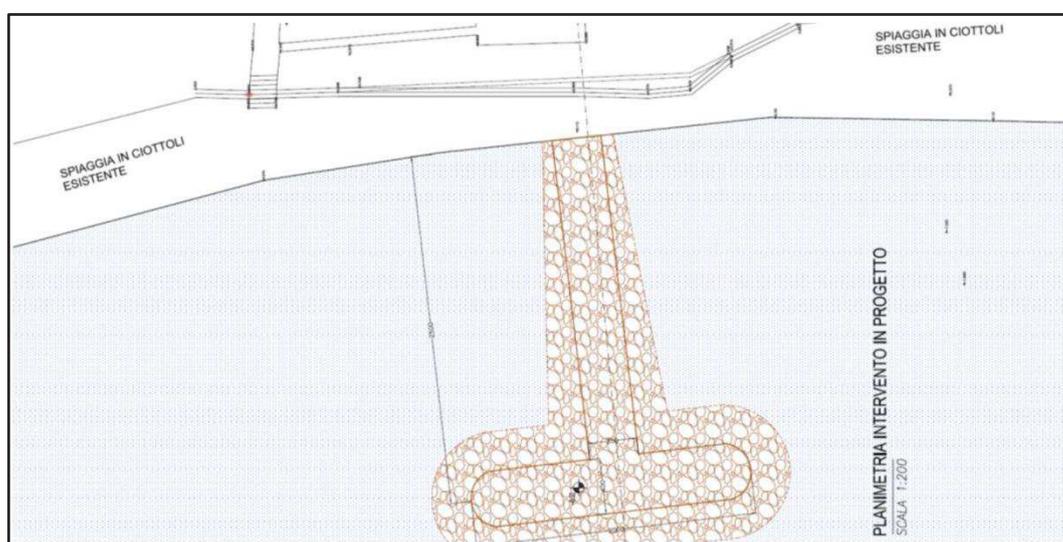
Pianta di intervento (all. 05A del progetto preliminare)
